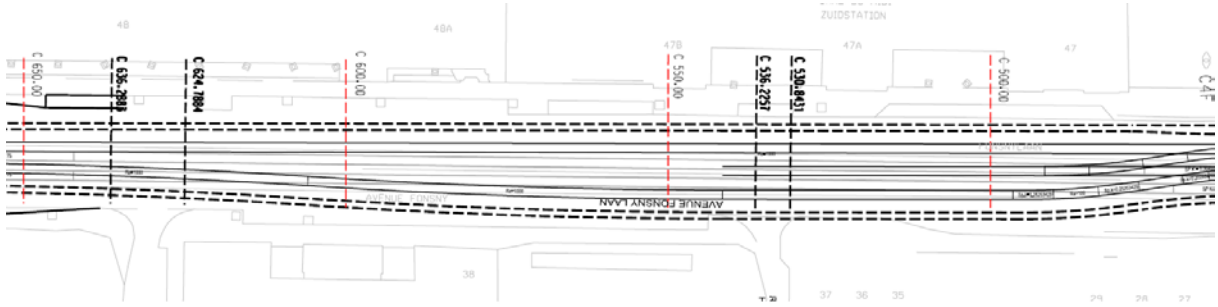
Vue en plan – tracé souterrain tram avenue Fonsny
